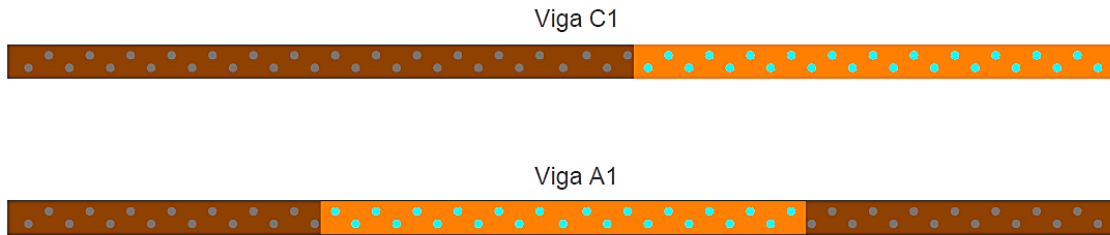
Esquemas de reparação das vigas C1 e A1 (vista em planta)
